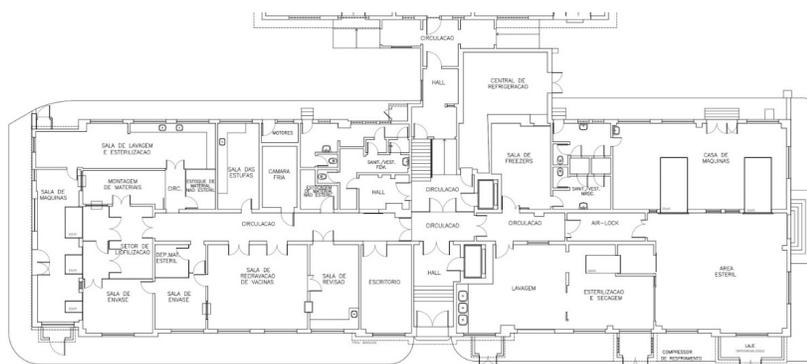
Planta baixa 1º pavimento - Pavilhão Rockefeller.
